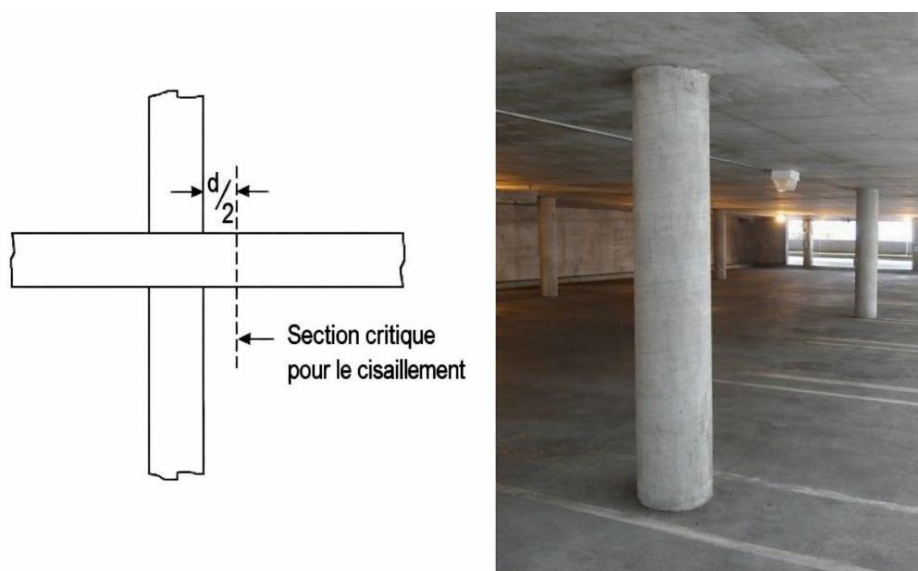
Dalle pleine sans retombée de panneau et tête de poteau [13]
